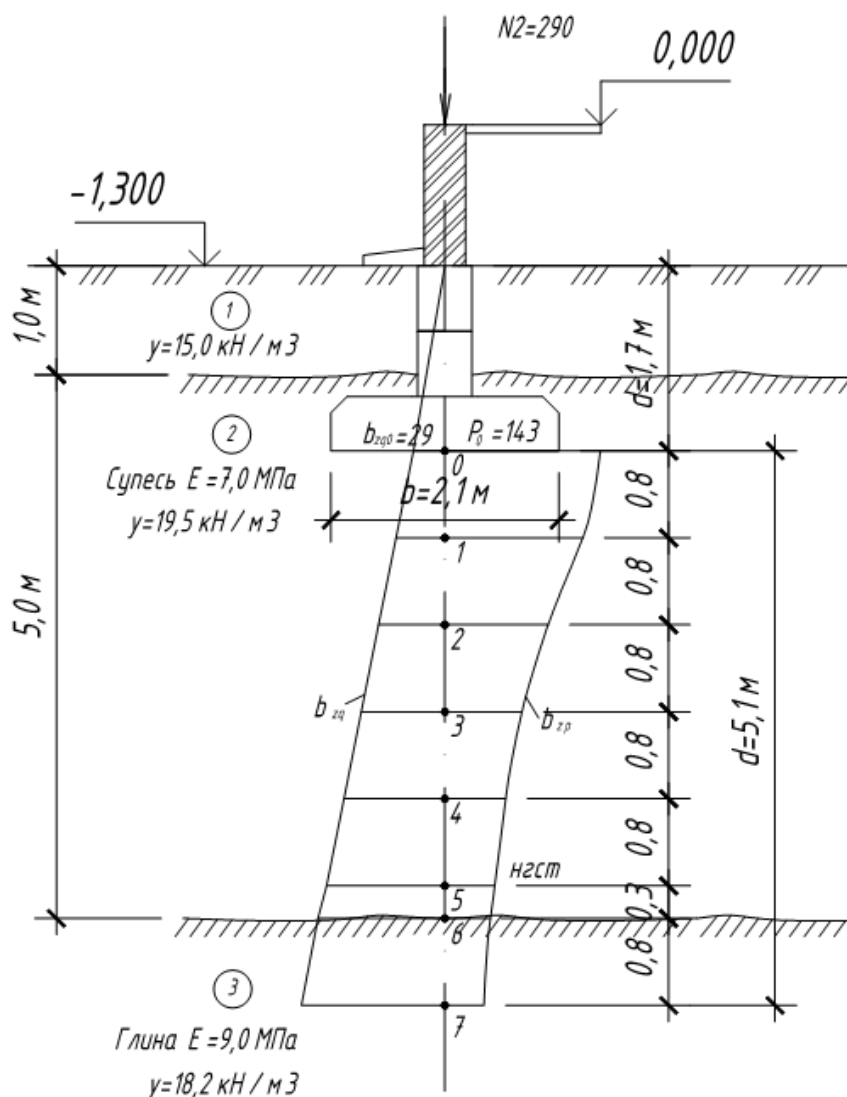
Схема расчета осадки фундамента на естественном основании
